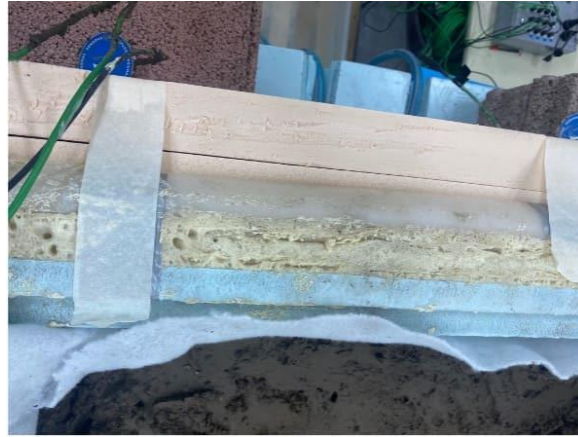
Sección de la Caja de Prueba con el aislamiento térmico utilizado.
